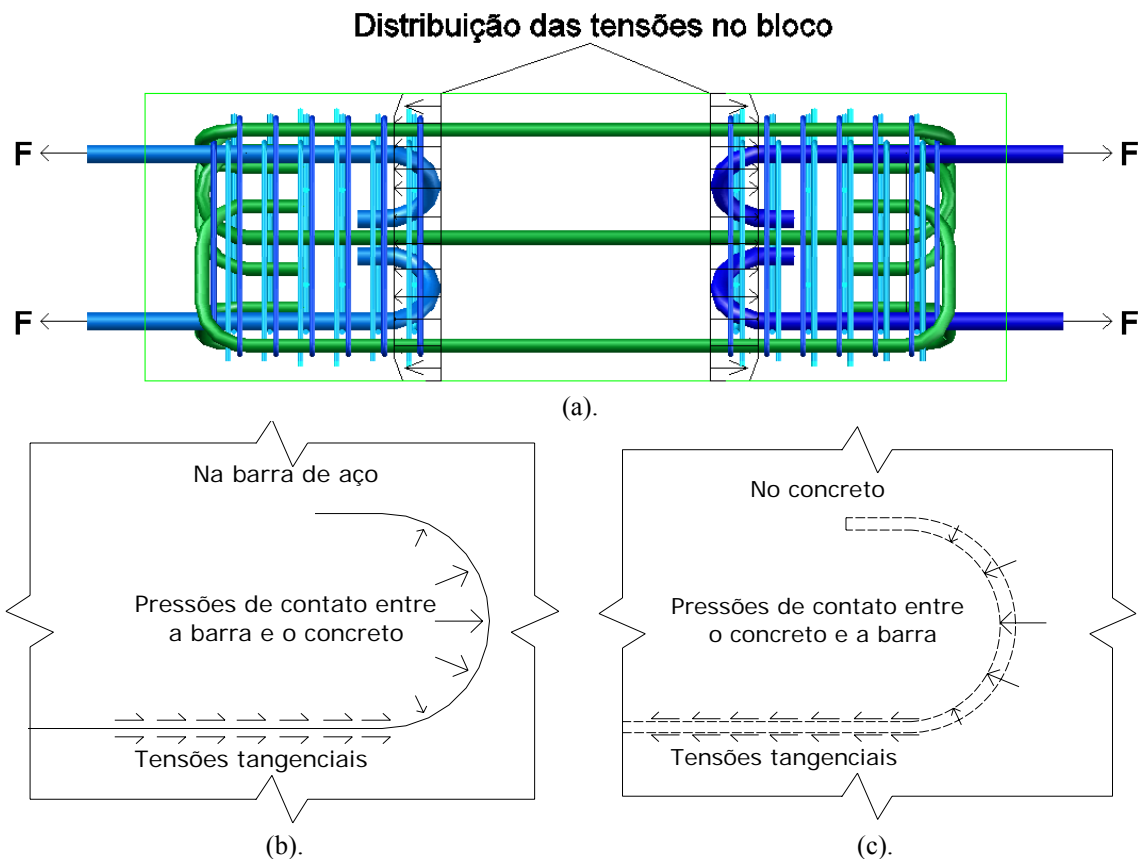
(a) Distribuição das tensões no bloco; (b) Tensões tangenciais na barra de aço e pressões de contato entre a barra e o concreto e (c) Tensões tangenciais no concreto e pressões de contato entre o concreto e a barra.
